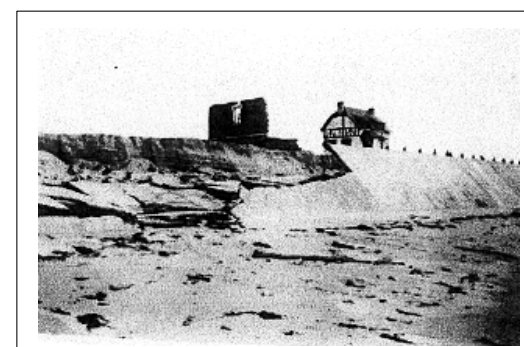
Photo des dégâts sur les voiles en béton armé (Octobre 1949)
